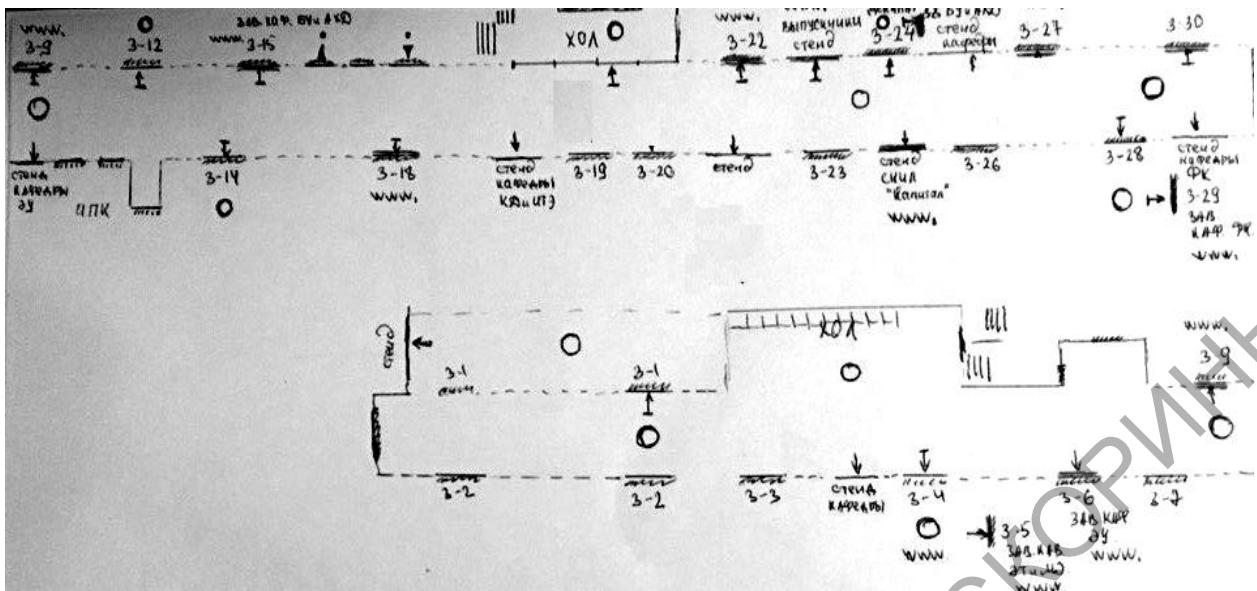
Основные точки обзора 3 этажа корпуса № 4
